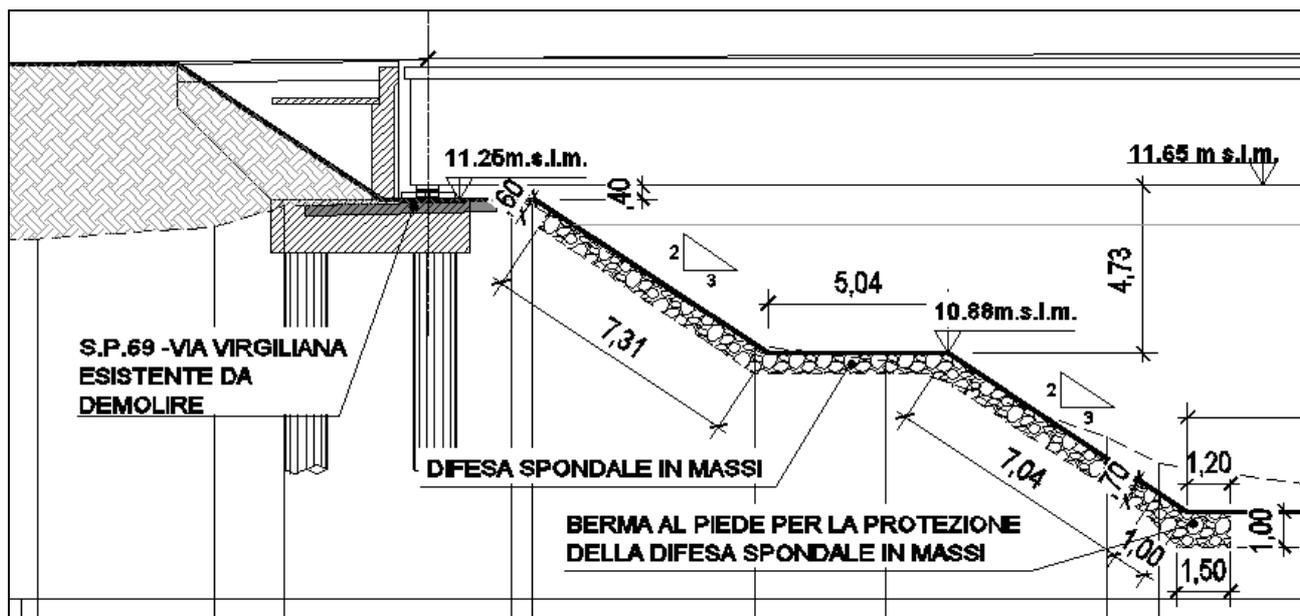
PARTICOLARE DIFESA SPONDALE
